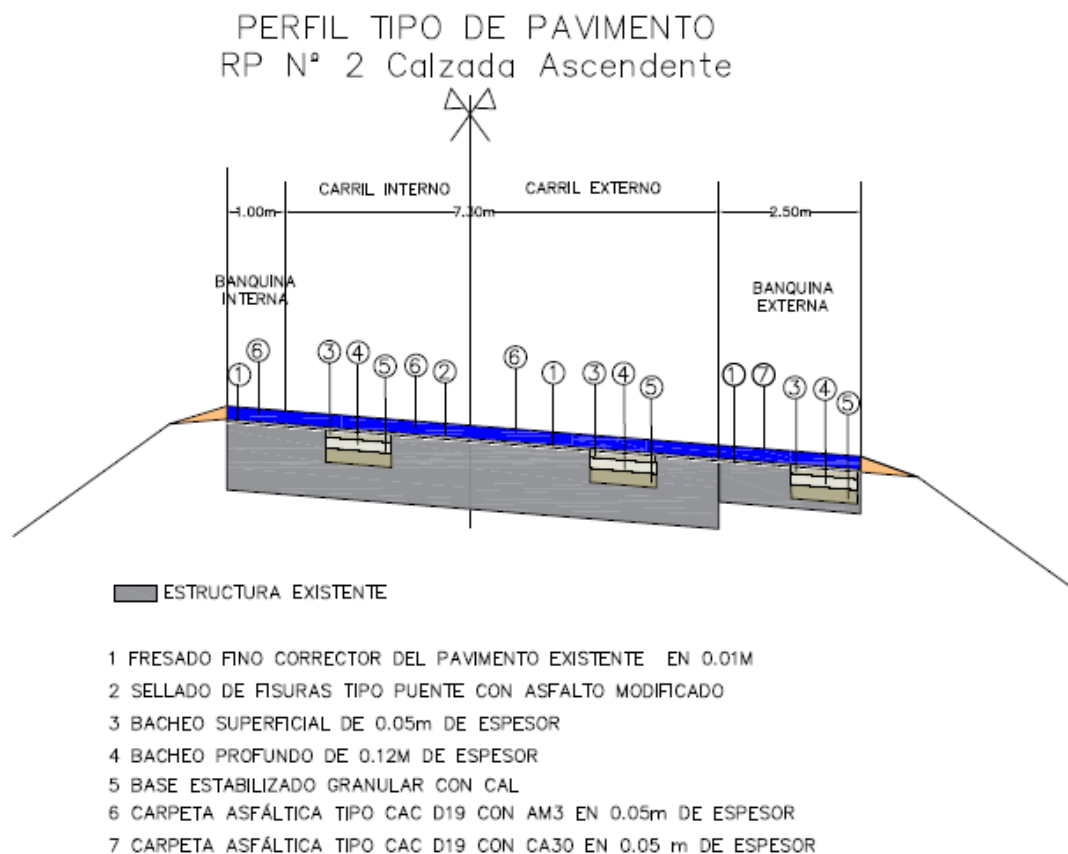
Perfil Tipo de Pavimento del Tramo I de rehabilitación en R.P. N° 2 – Calzada Ascendente
